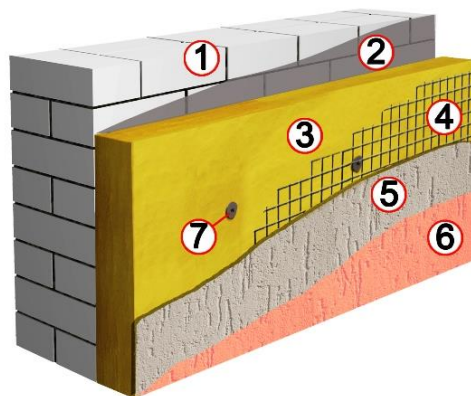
Схема утеплення фасаду "мокрим" методом:
